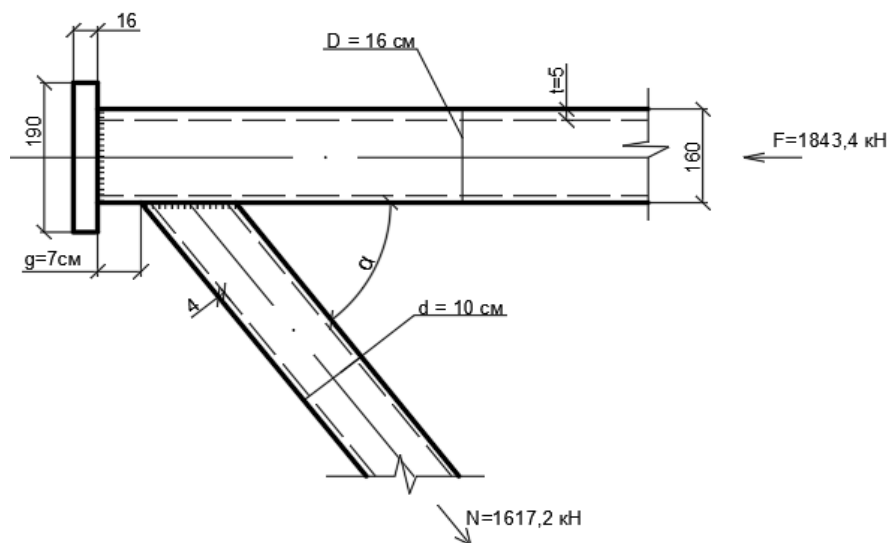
Опорный узел стропильной фермы (исходные данные для расчета)
